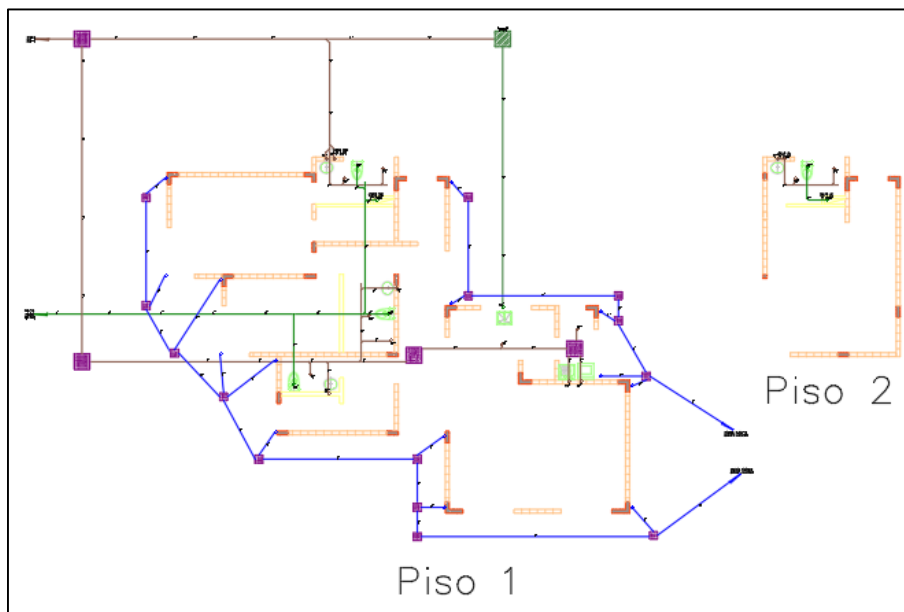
Red de desagüe proyecto Envigado construcción sostenible.
